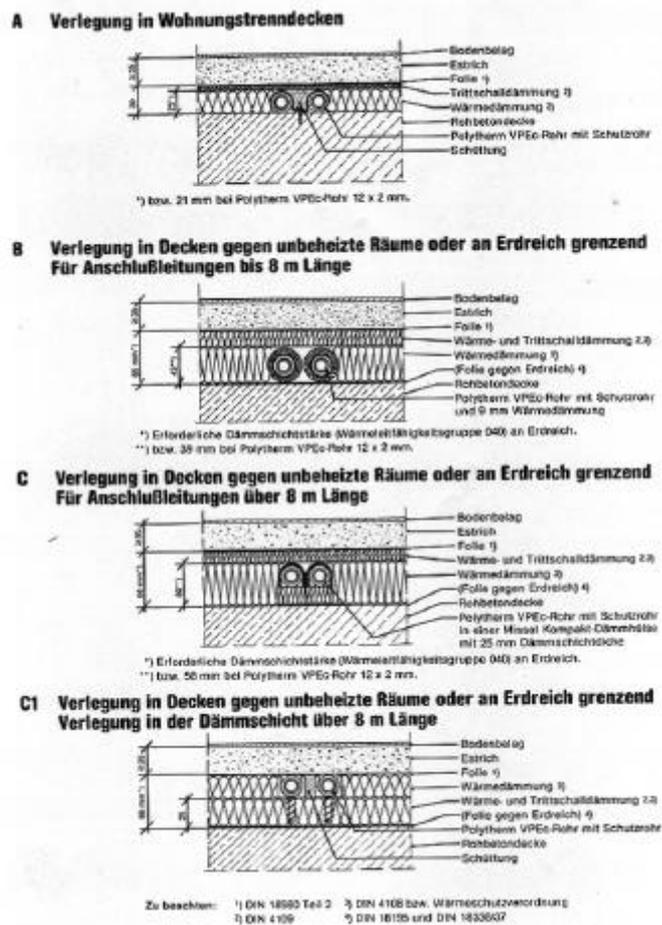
Fußbodenaufbau und Wärmedämmung der Heizleitungen [TGA 1/97]
